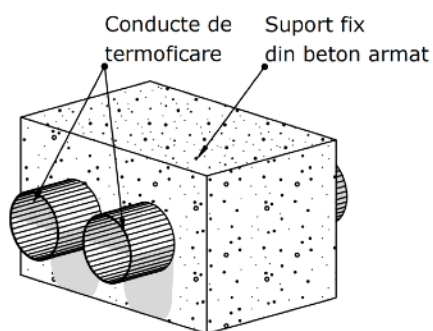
Suporturi fixe din beton armat pentru conducte de termoficare
